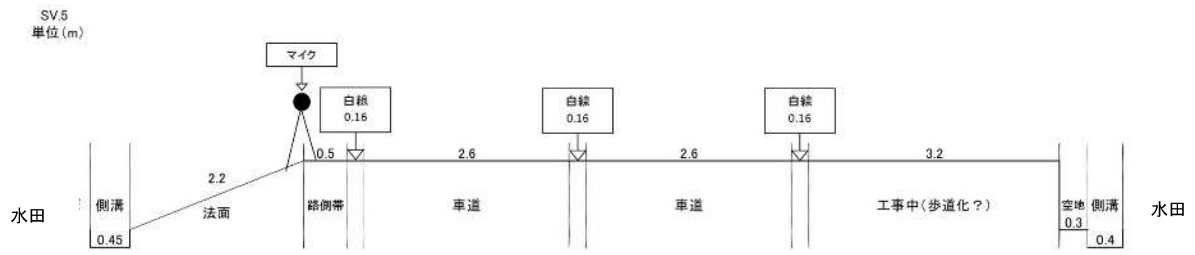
(3) 道路構造断面図 (SV.5)
